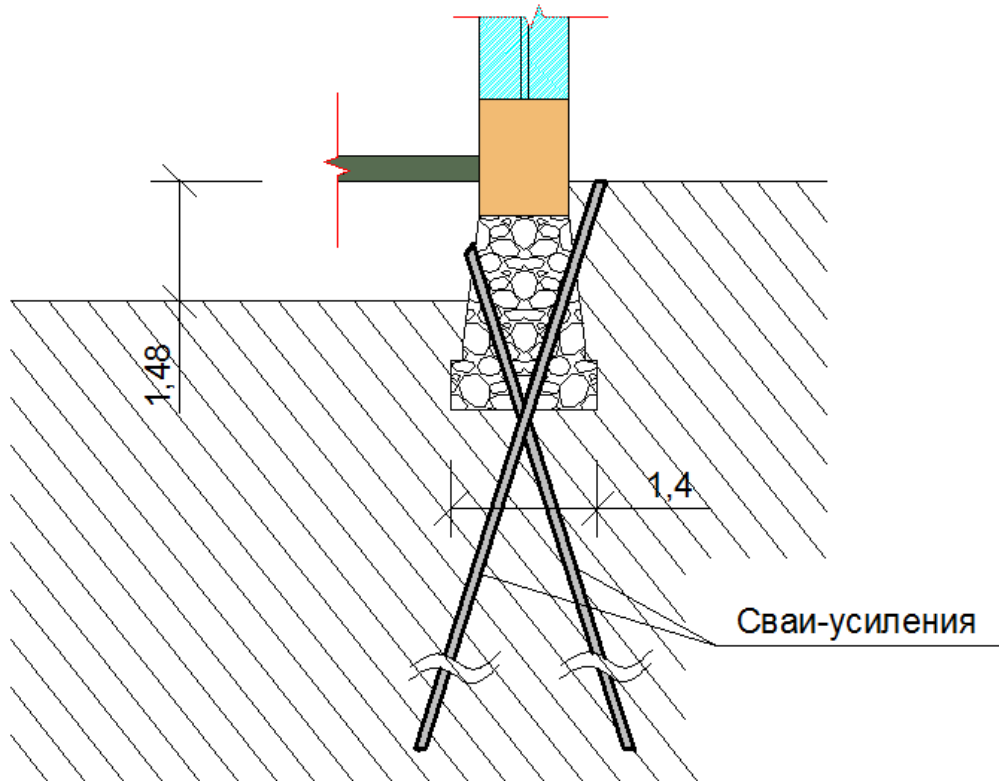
Схема пересадки фундаментов здания на сваи усиления
